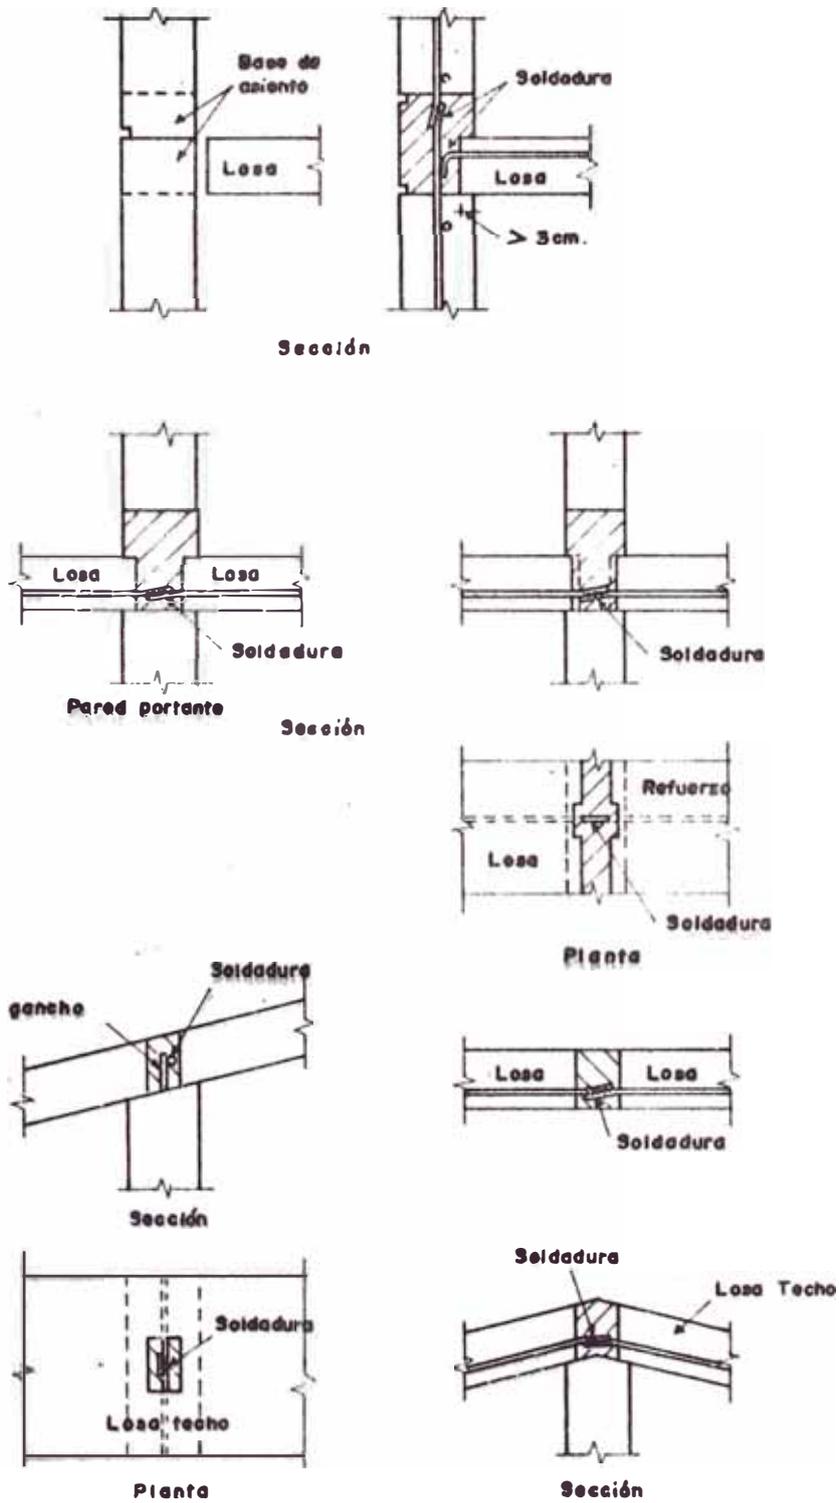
Junta entre Losa de Piso (Losa de Techo) y otros Miembros
